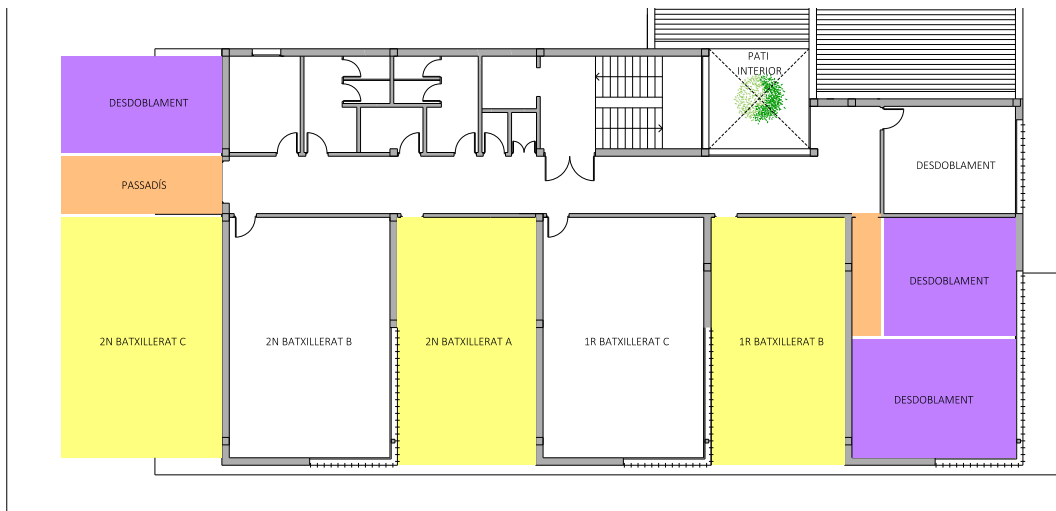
Proposta 2, Edifici D, Planta Segona. Font: Elaboració pròpia.
